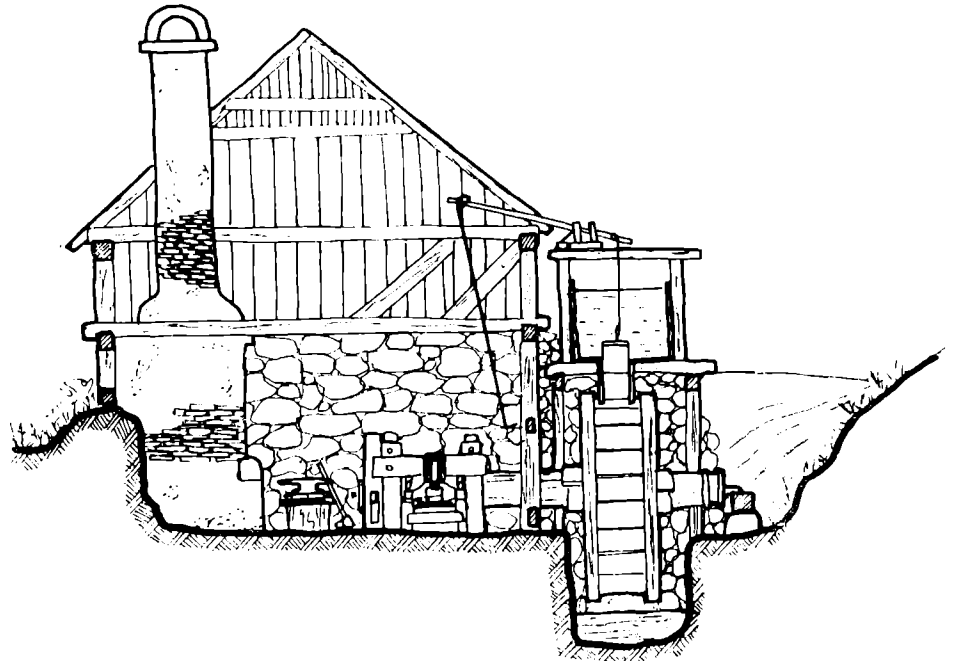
Plan și secțiune prin ciocanul hidraulic de la Rimetca (j. Alba)
